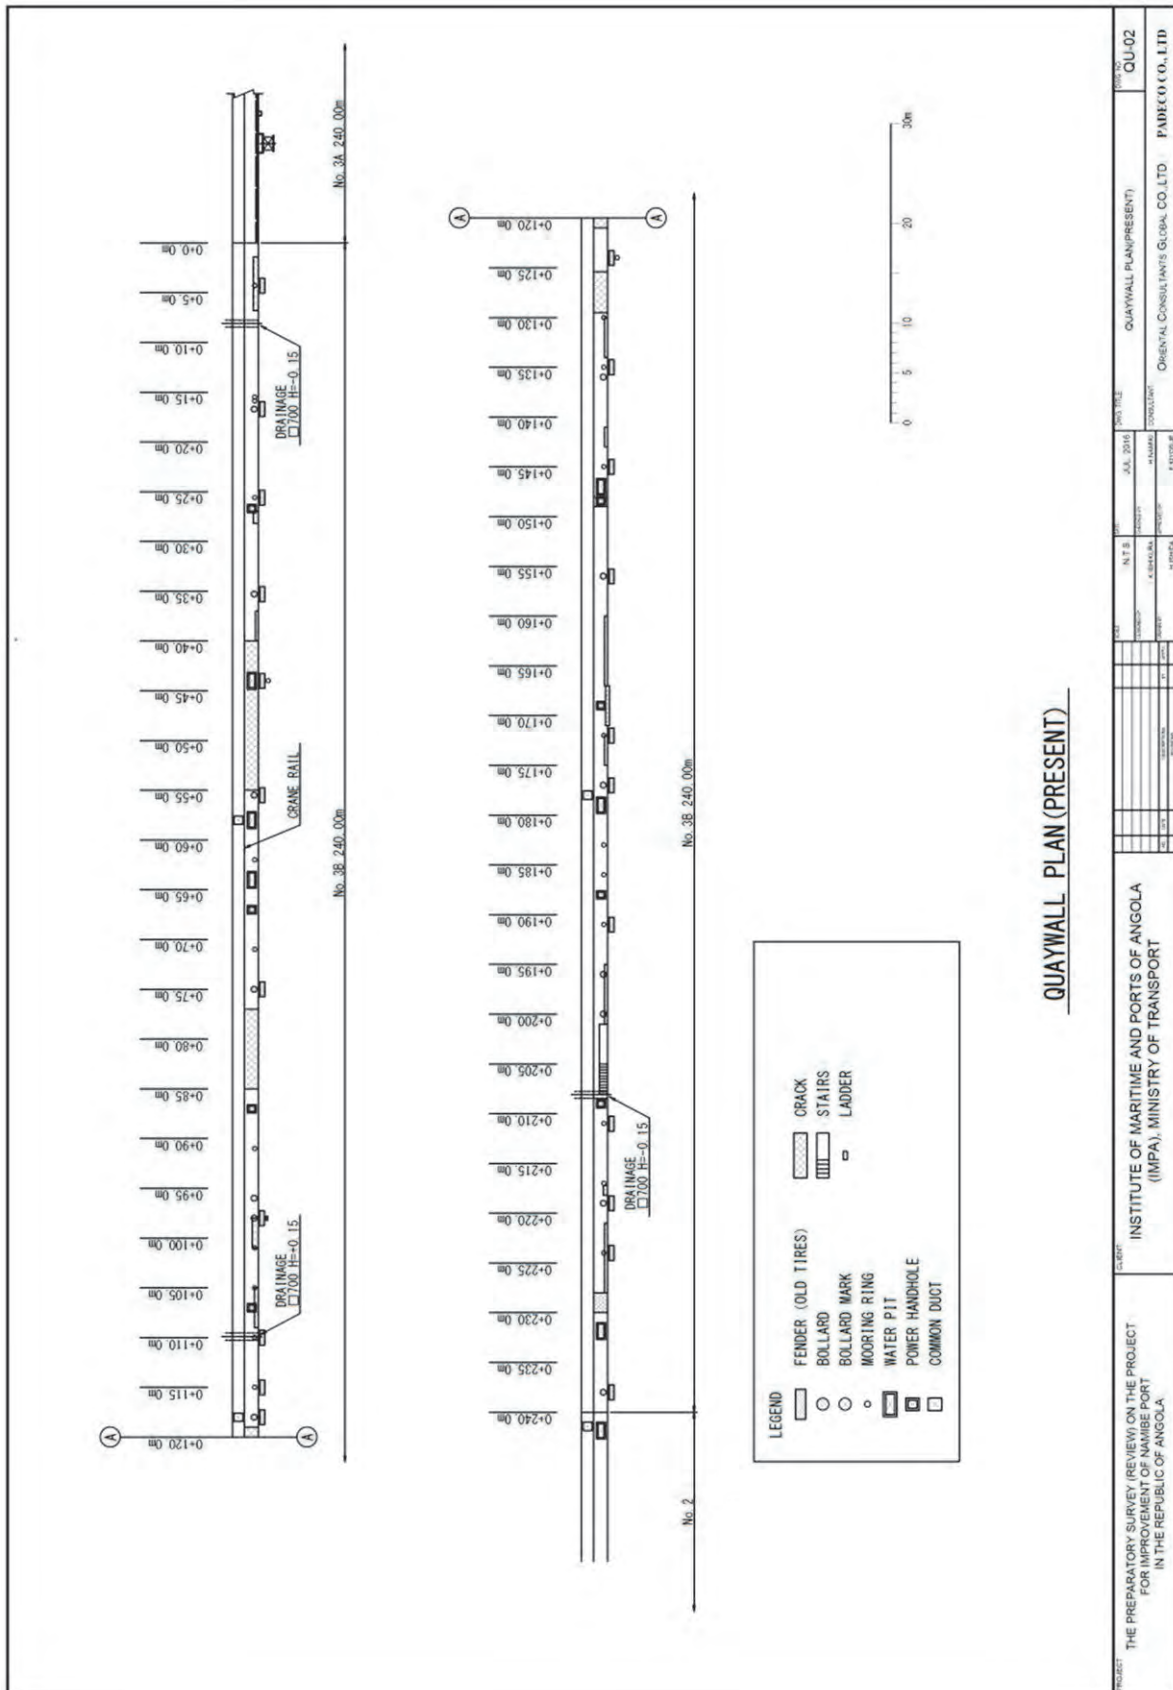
ナミベ港 No.3B 岸壁現況平面図
